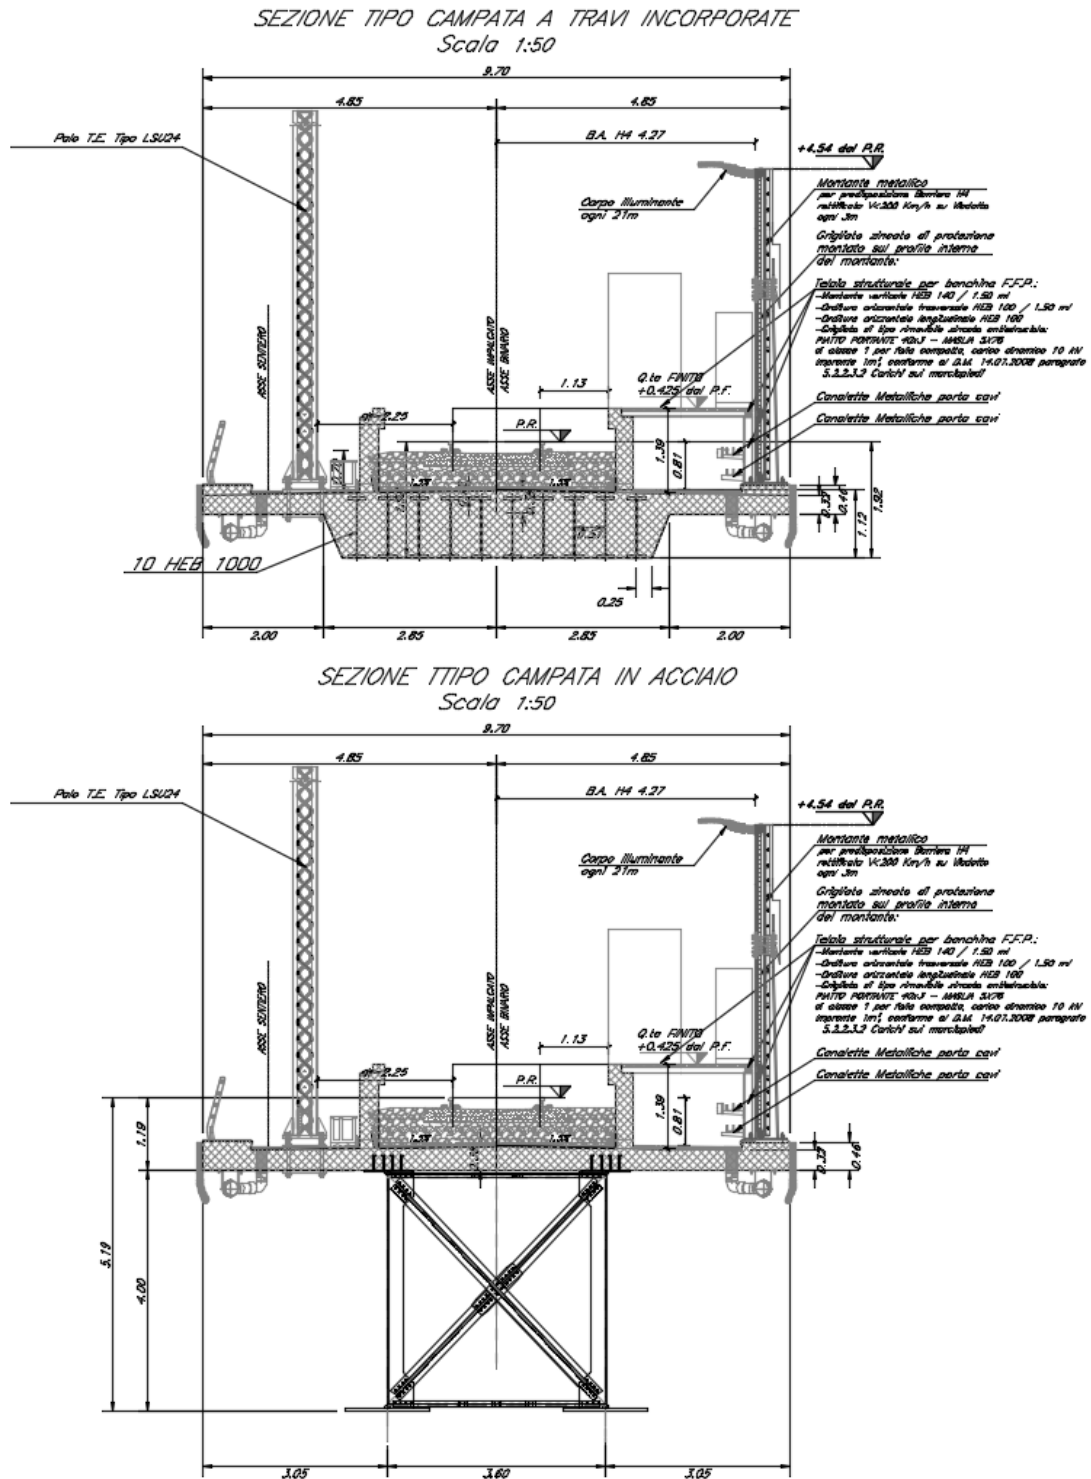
Ponte sul Torrente Fondaco Parrino: sezioni trasversali e prospettiva binario pari
